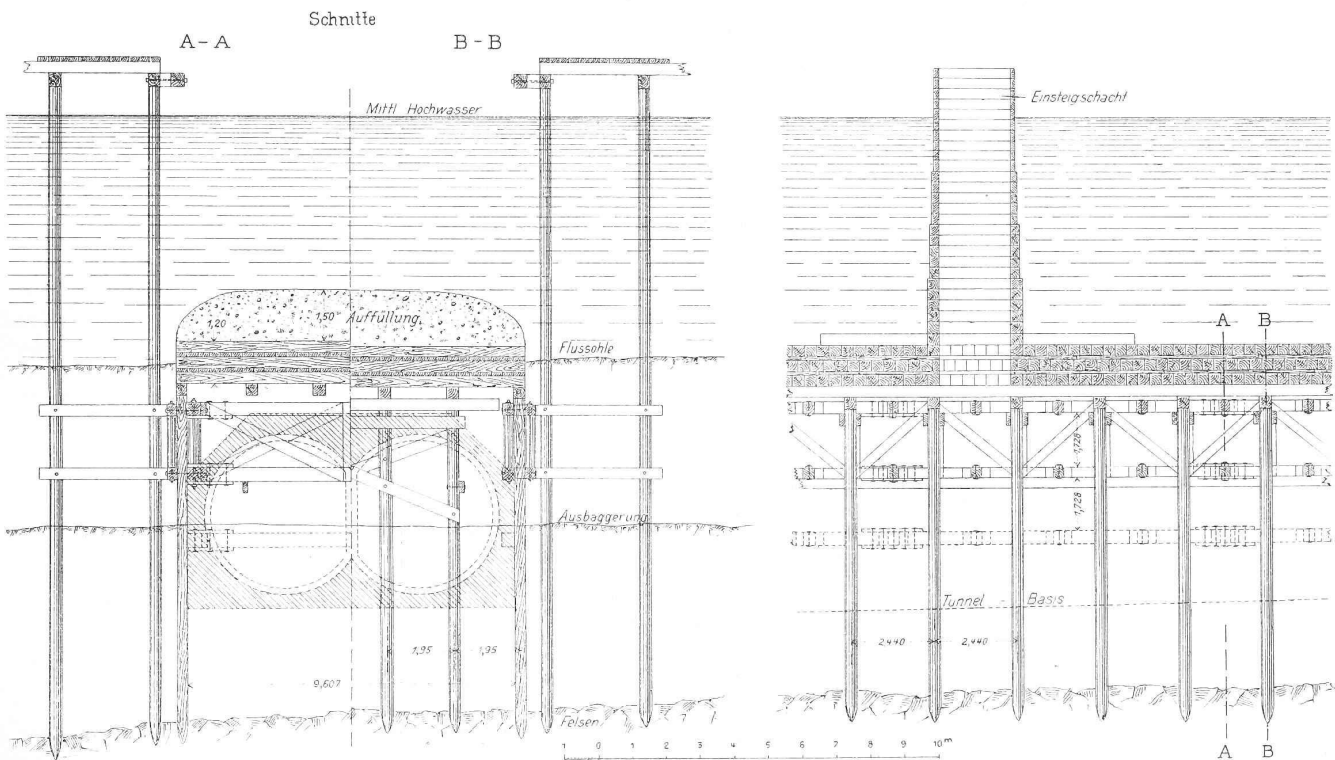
u. 11. Querschnitt und Längsschnitt der Gerüste und der hölzernen Caissons für den Bau des Tunnels unter dem Harlemfluss. — 1 : 200.
